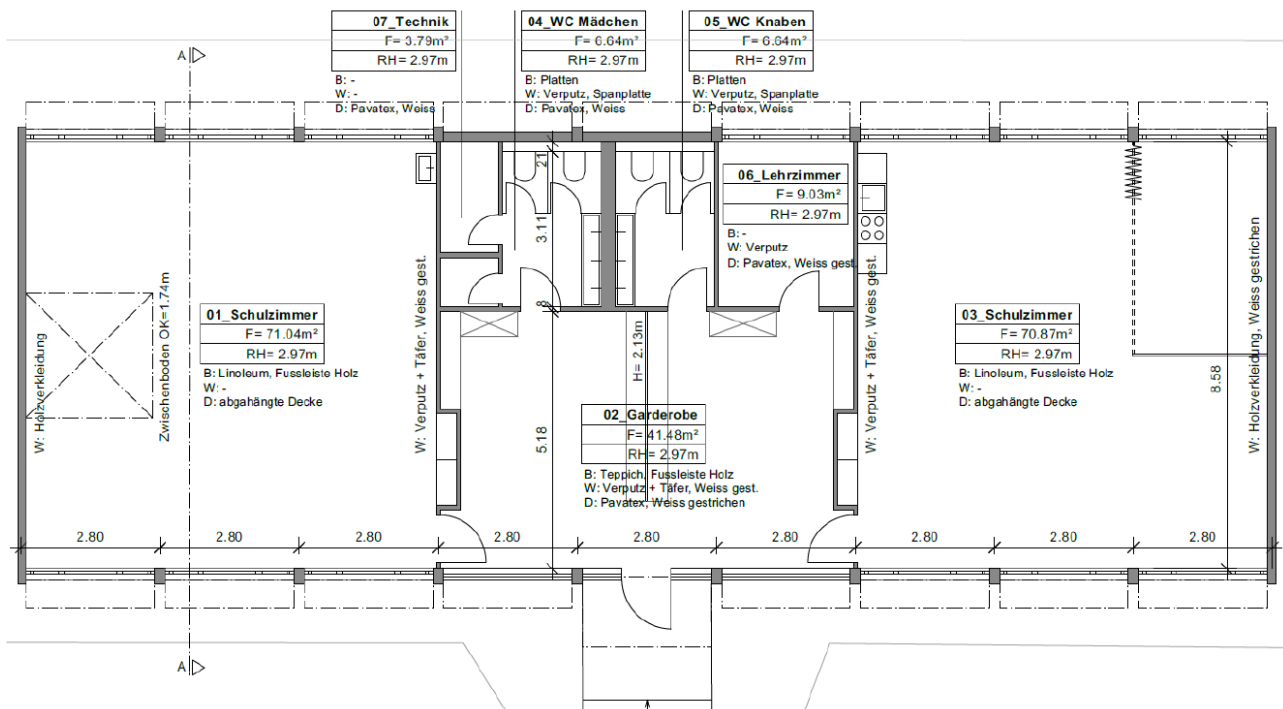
Grundriss Variel-Pavillon bei Schulanlage Mösli
